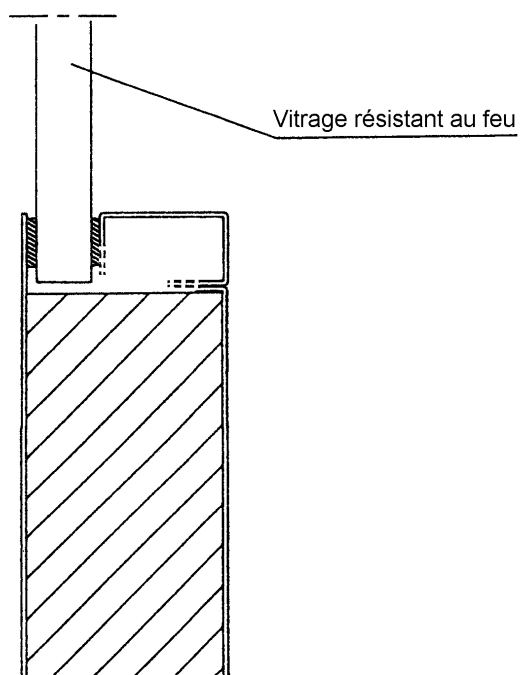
Coupe du vantail à l'endroit des pareclozes
